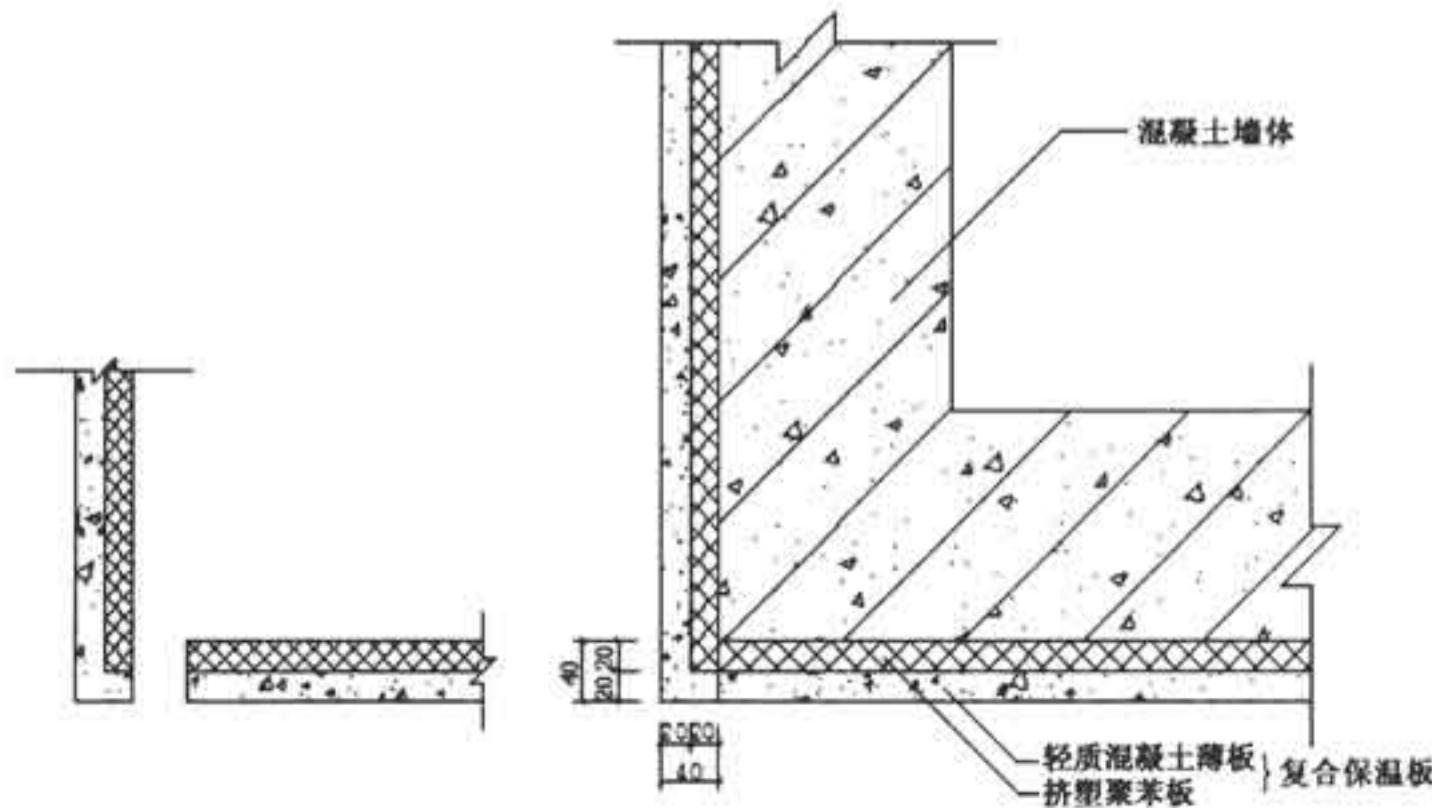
4-1 混凝土外墙（柱）阳角处配板示意
